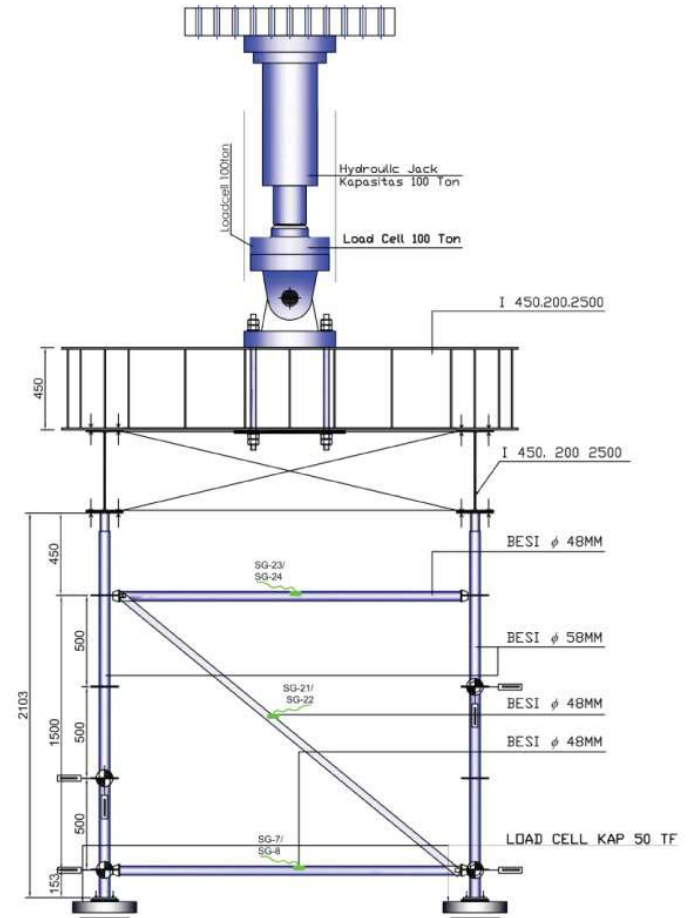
Tipe *scaffolding* baja yang ditinjau (Dewobroto 2016)
